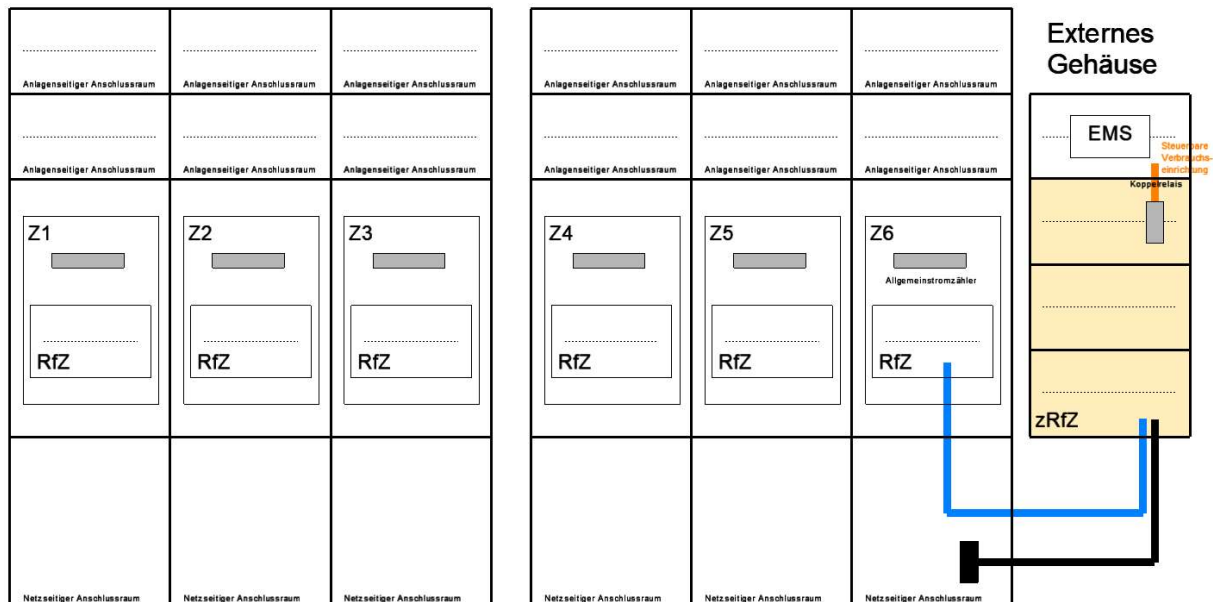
Bestandszählerplätze ohne zusätzlichen Zählerplatz bzw. Steuergerätefeld
